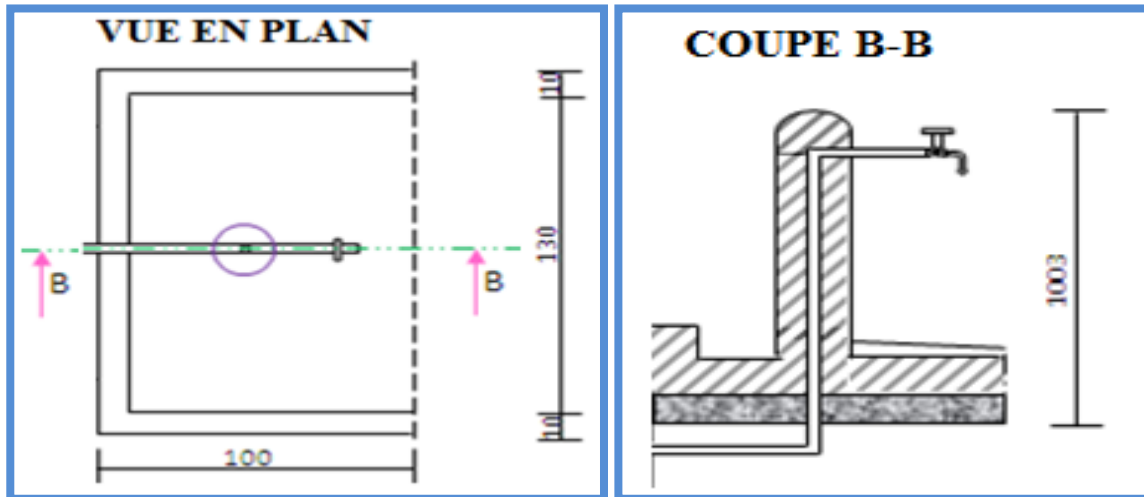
Vue en plan et coupe d'une borne fontaine
